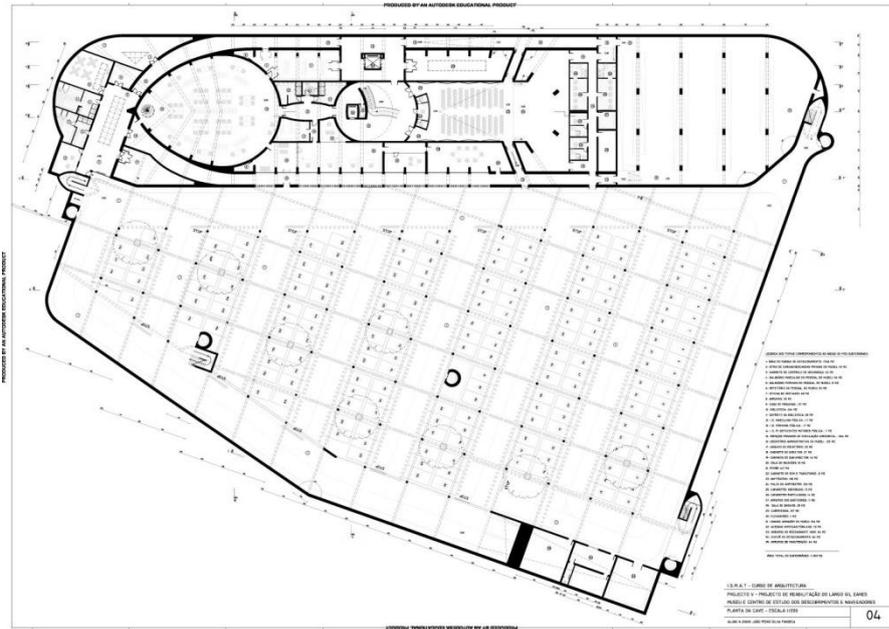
Planta da Cave do Museu e estacionamento subterrâneo.
